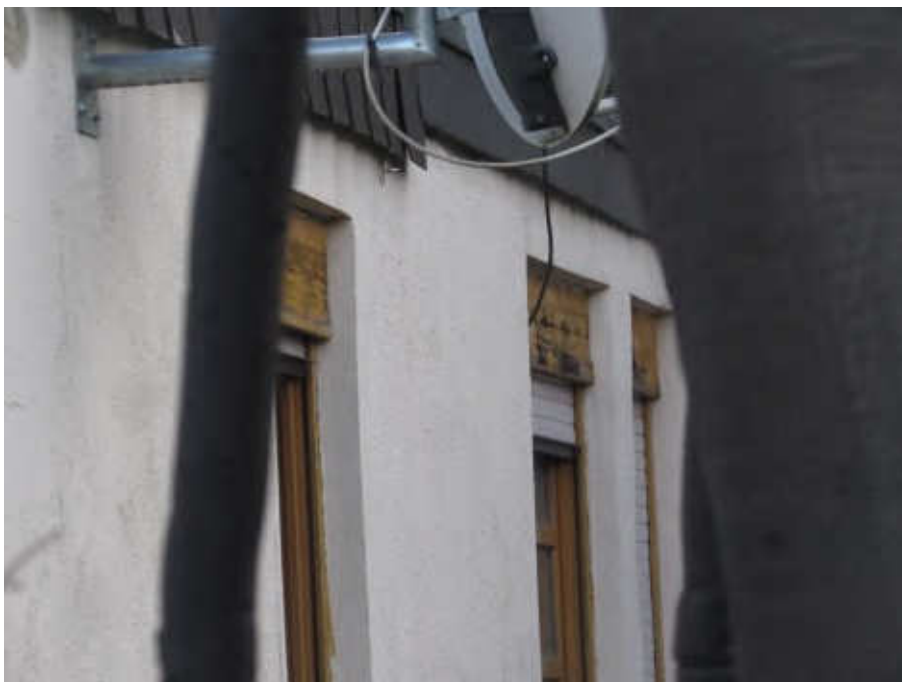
nicht ordnungsgemäß verbaute Rollladenkästen im Bereich des Anbaus II
